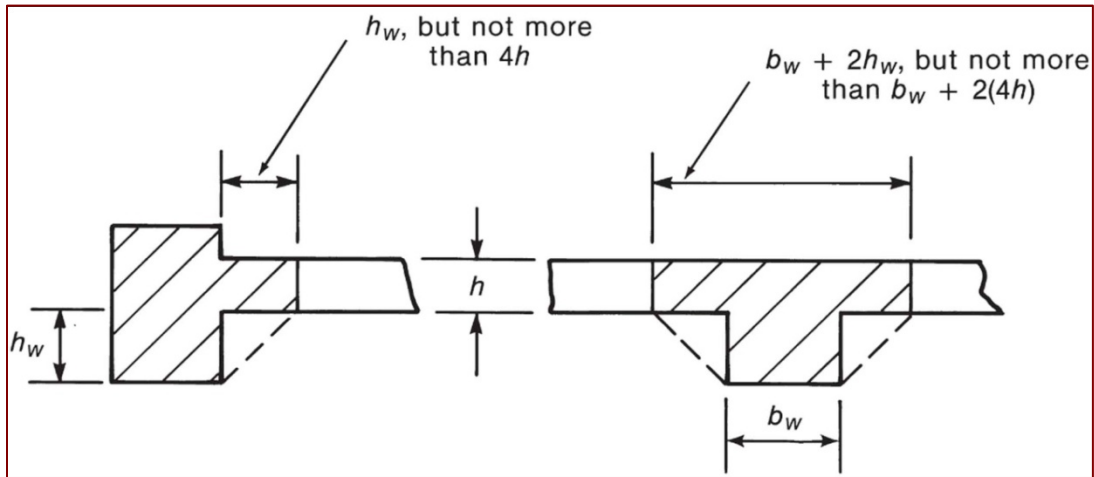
Secciones transversales de vigas según definición de ACI 318 13.2.4.
